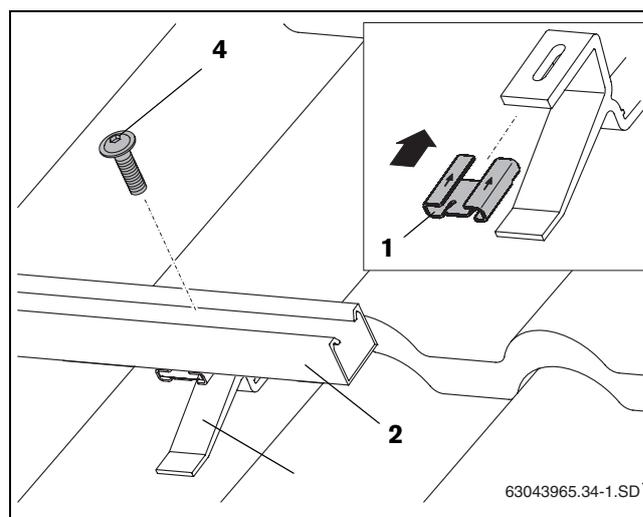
Fissaggio delle guide profilate con i ganci da tetto
